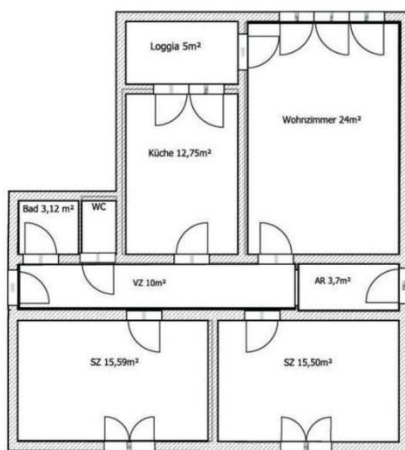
Grundrissbeispiel Berliner Ring
